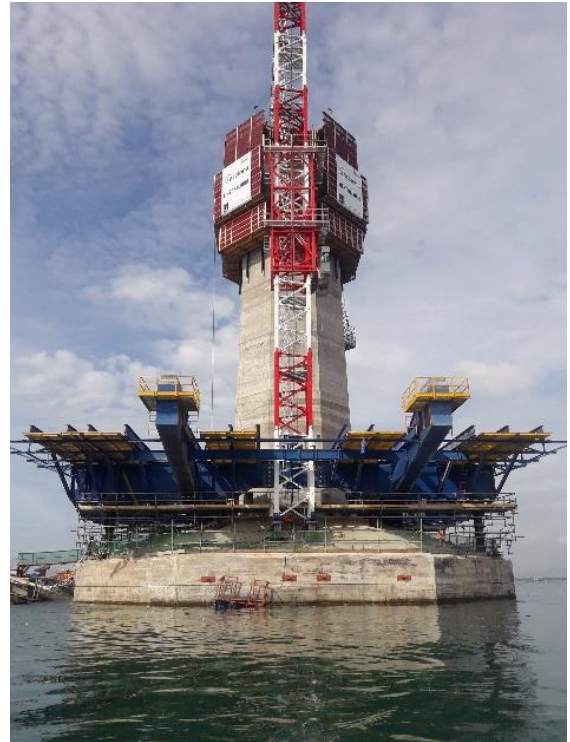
Montaje del equipo sobre el encepado con la grúa torre integrada y el encofrado trepante del pilón operativo
